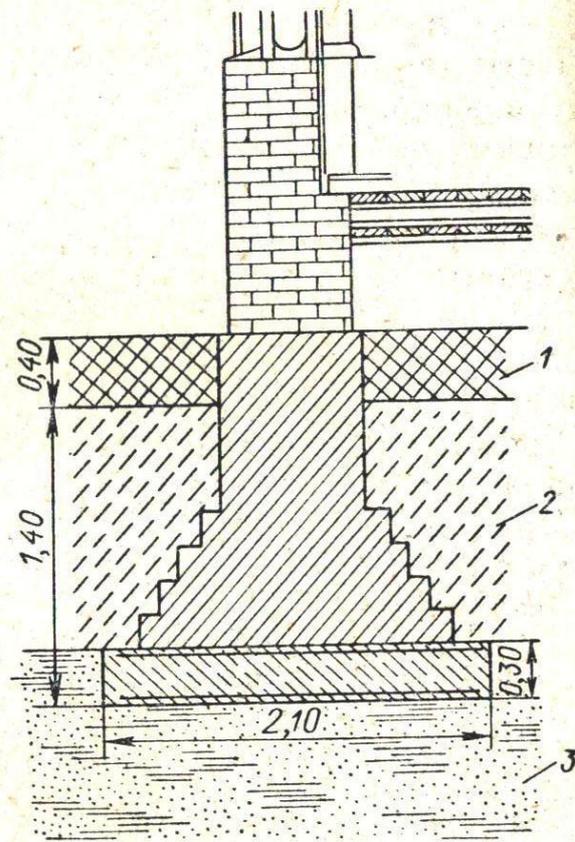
Фундамент, расположенный на пльвуне. В основании фундамента железобетонная подушка (по М. И. Евдокимову-Роковскому).
